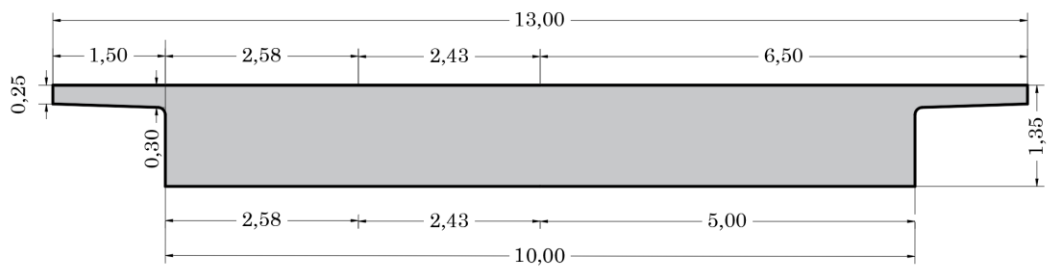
Sección transversal del puente sección maciza en apoyo (Fuente: Elaboración propia).
